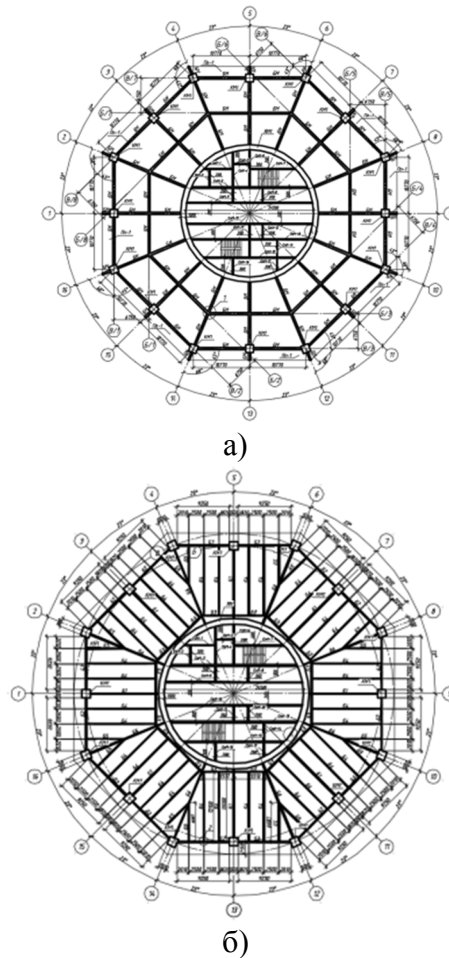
Схема влаштування перекриття із балочними плитами(а) по профільованому настилу (б)
